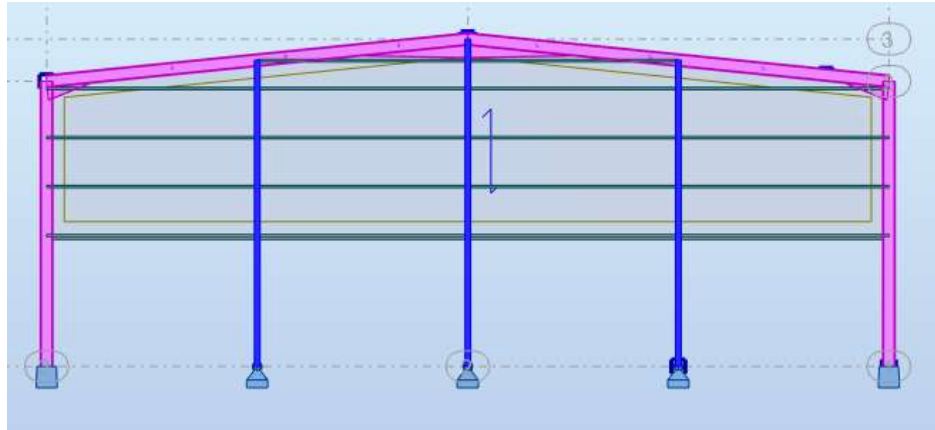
Disposition des potelets et les lisses sur la façade pignon.
